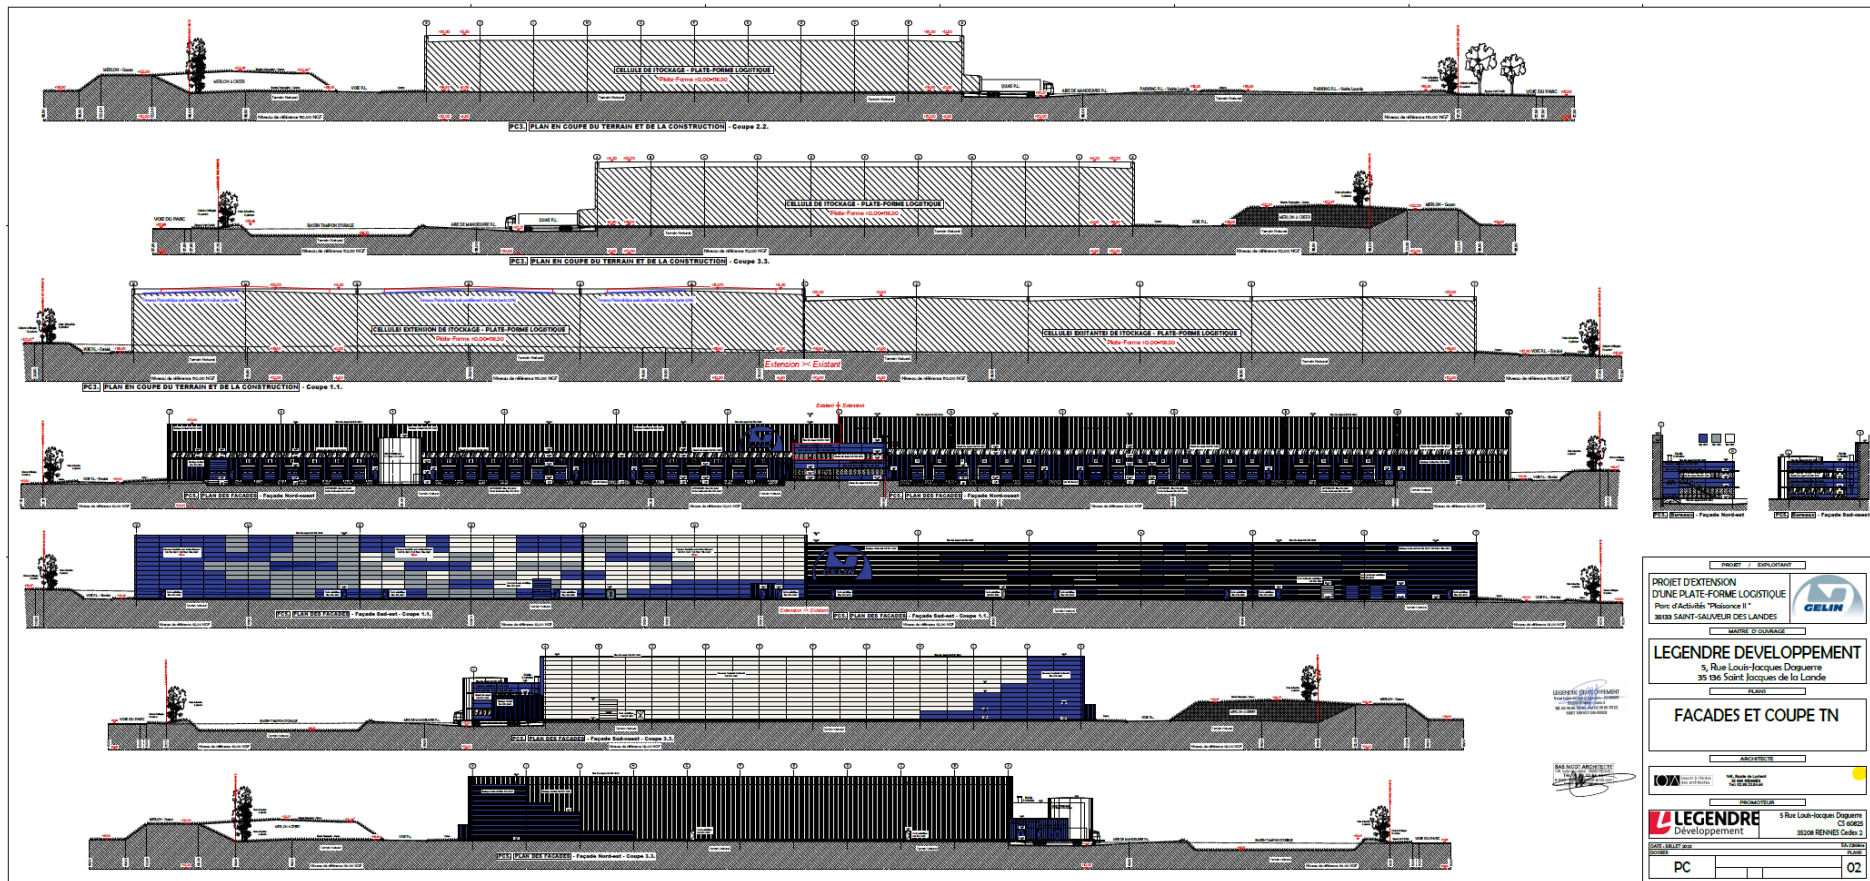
Plans de coupe et de façade (source : NICOT ARCHITECTE)
